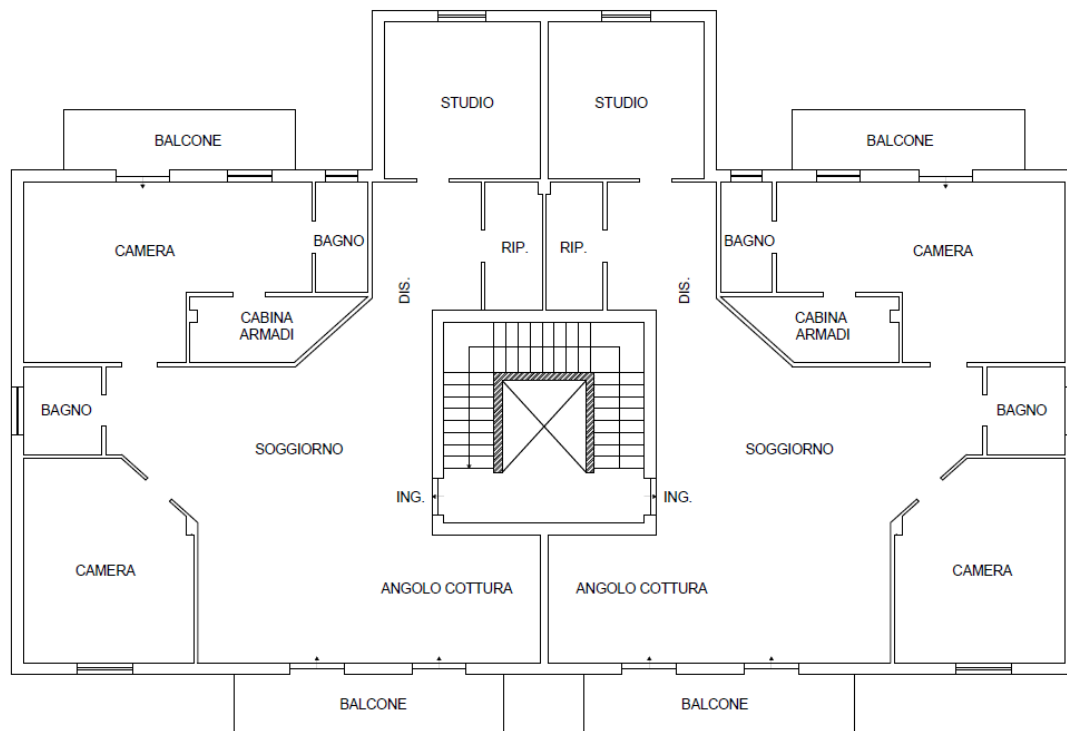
Planimetria piano tipo dell'edificio in esame
